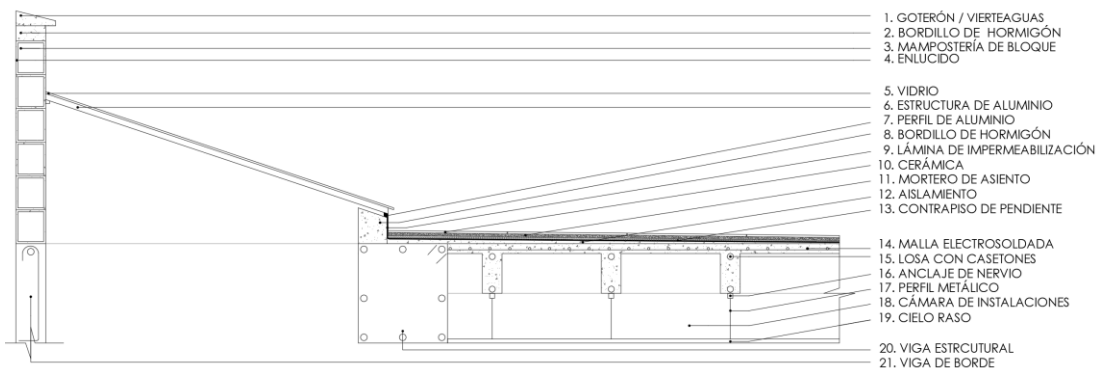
Detalle constructivo A-2 cubierta. Elaborado por el autor.
